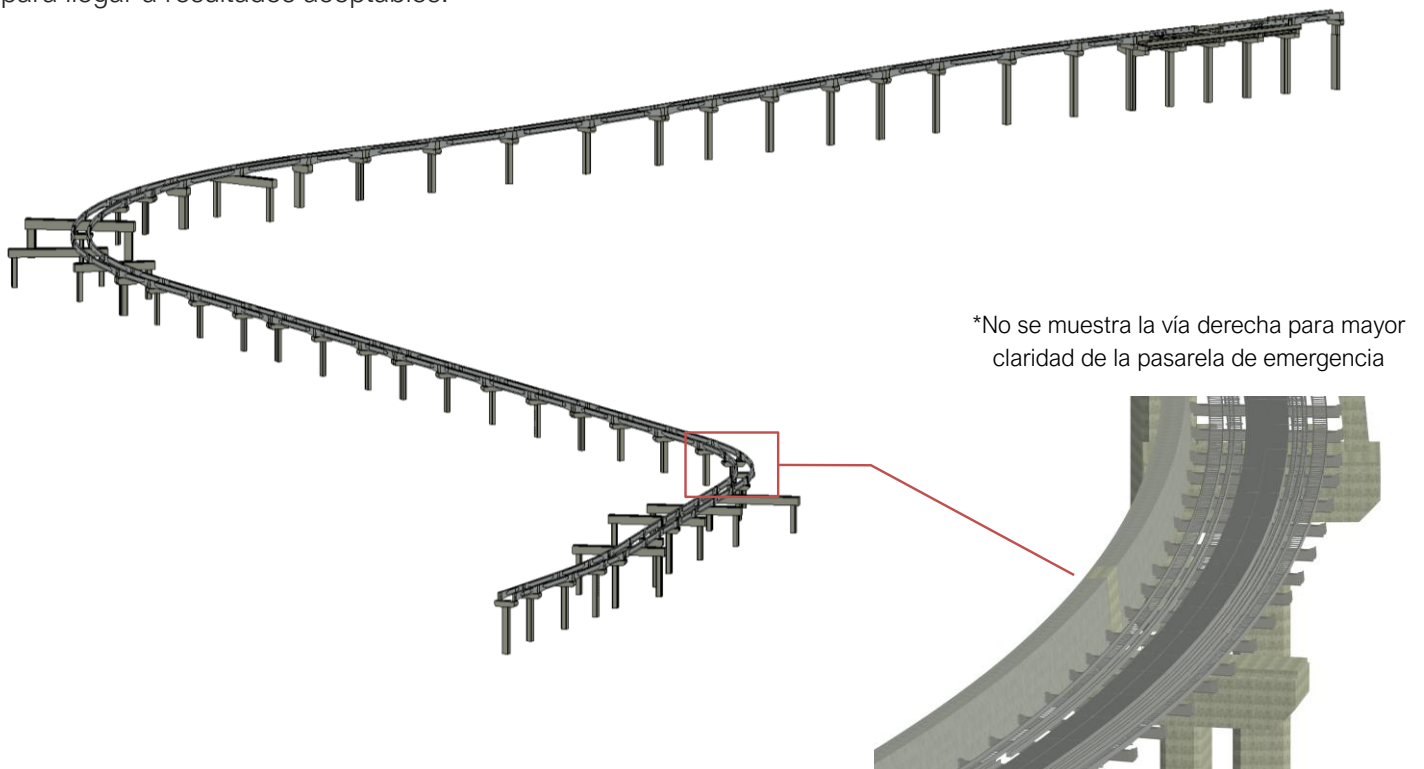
Modelo BIM de las estructuras de la vía guía y de las pasarelas de emergencia
